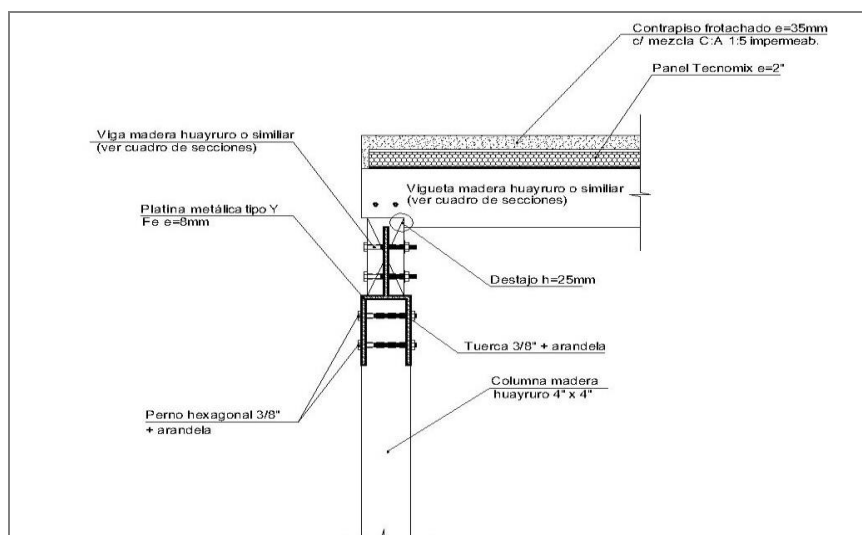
Vista en corte. Fijación con platina de vigas intermedia
